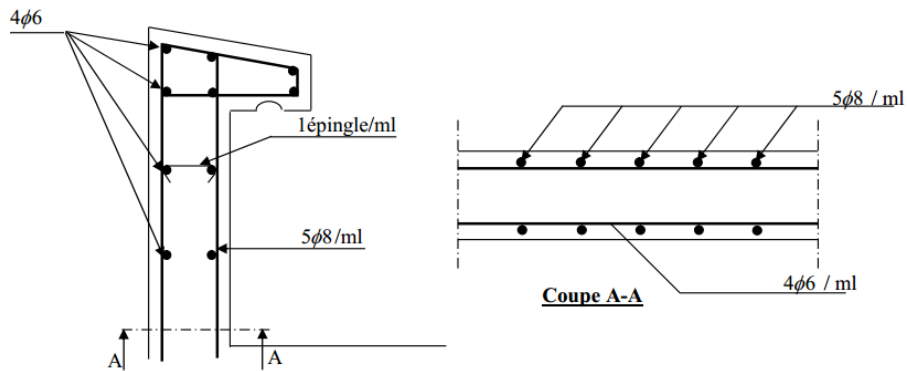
Plan de ferrailage de l'acrotère
